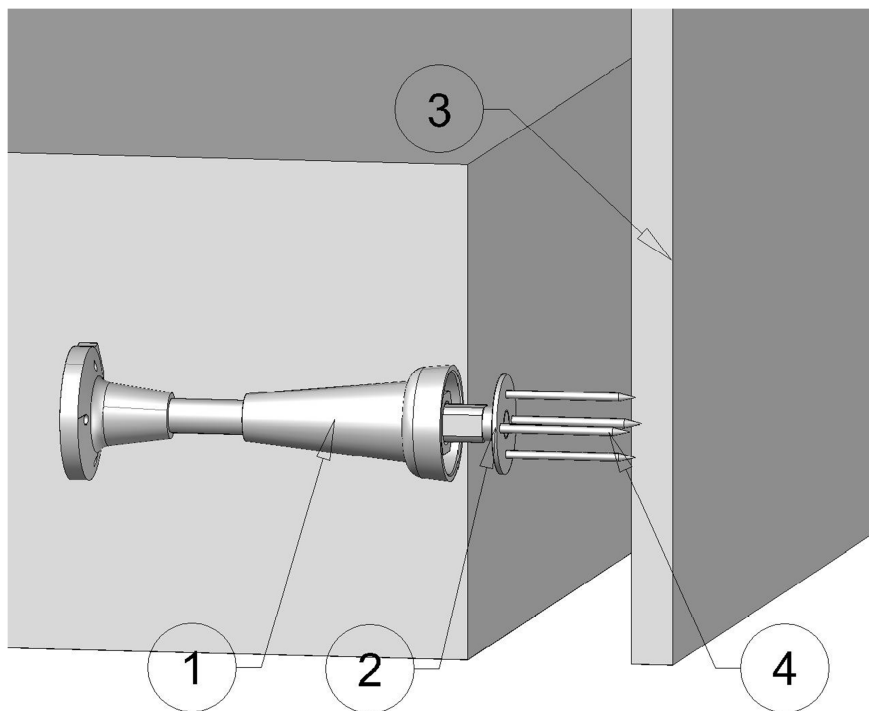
particolare del sistema di ancoraggio prima del getto - esplosivo
